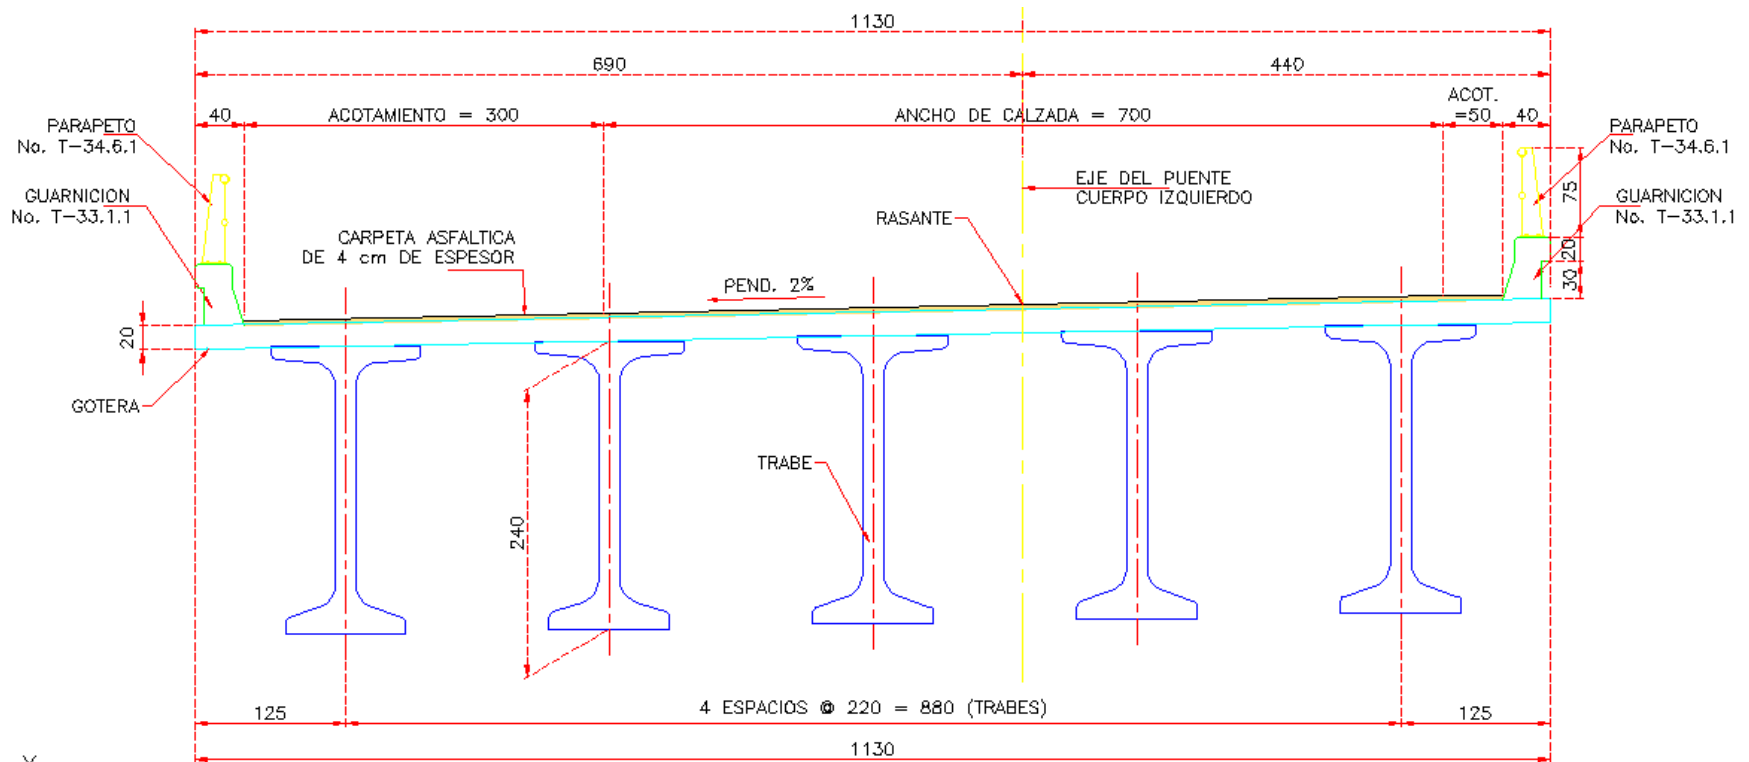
Sección transversal del puente mostrando las características de la estructura.
